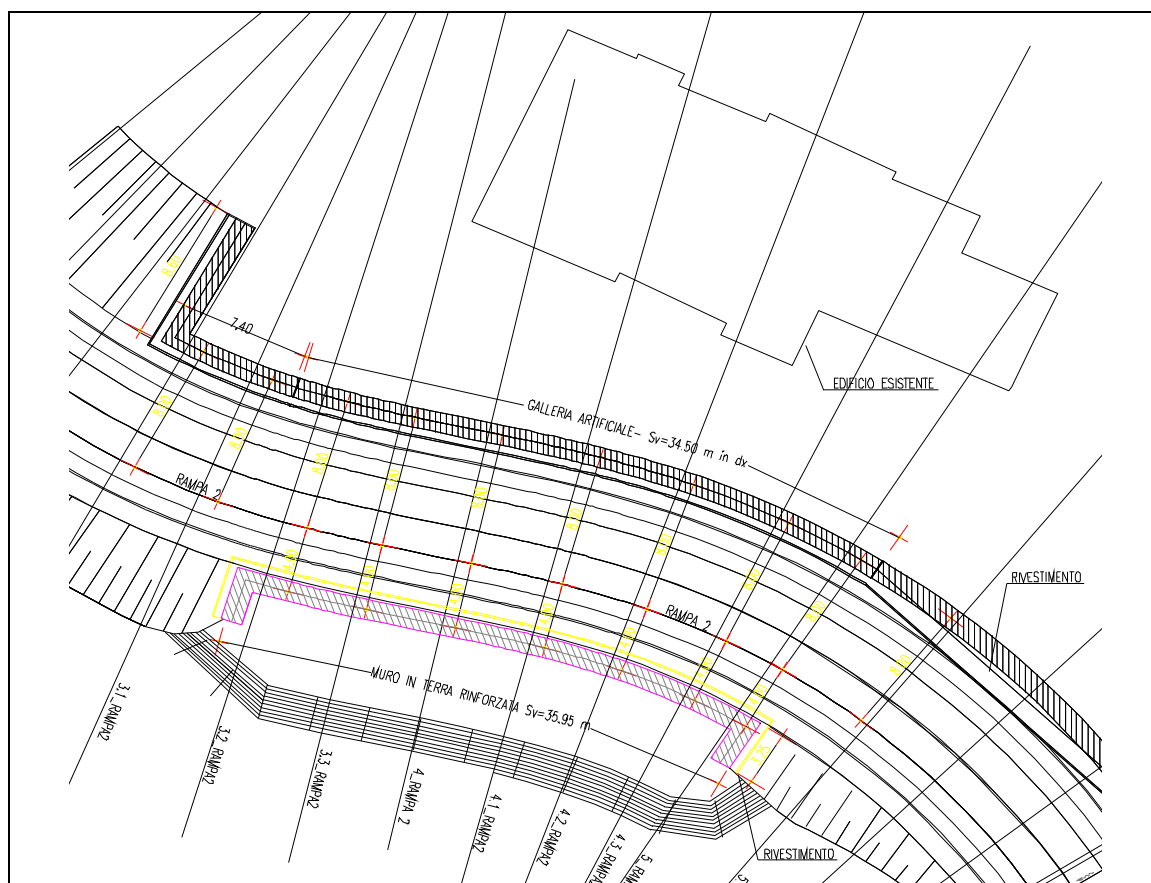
Stralcio planimetrico galleria artificiale RAMPA 2
